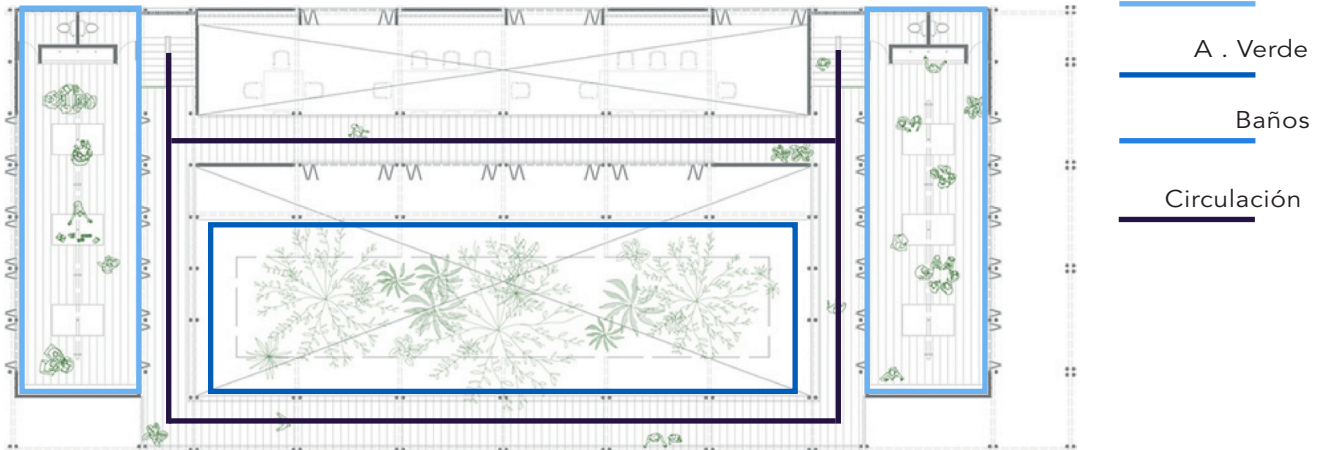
"Las Tejedoras" – Planta alta - Zonas
